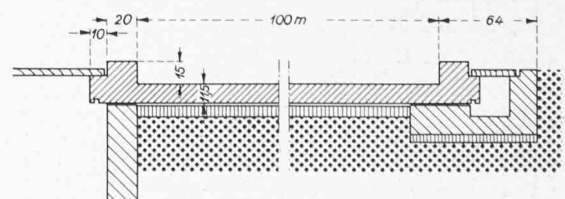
Querschnitt durch die Pistenplatte mit Ausbildung der Ränder, 1:50
